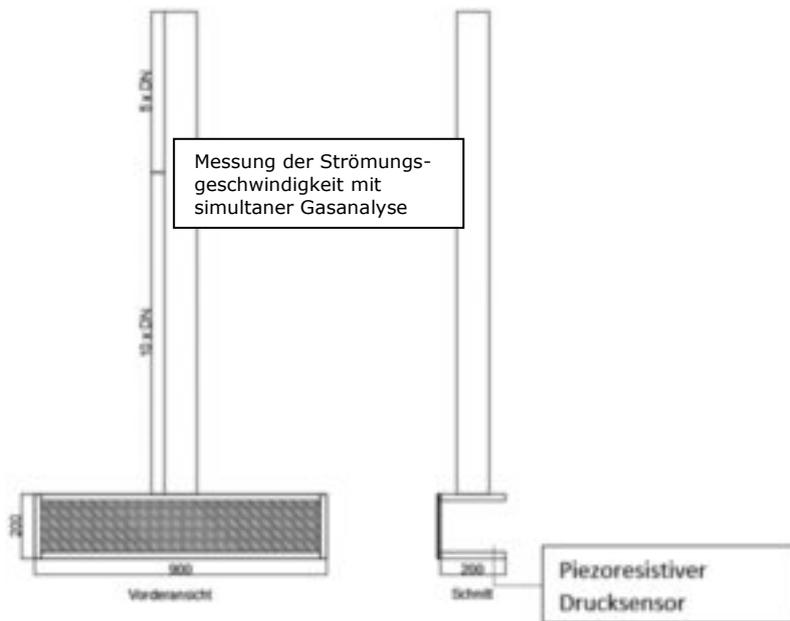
Detailzeichnung des RAK-Prototyps mit Position der Messtechnik
